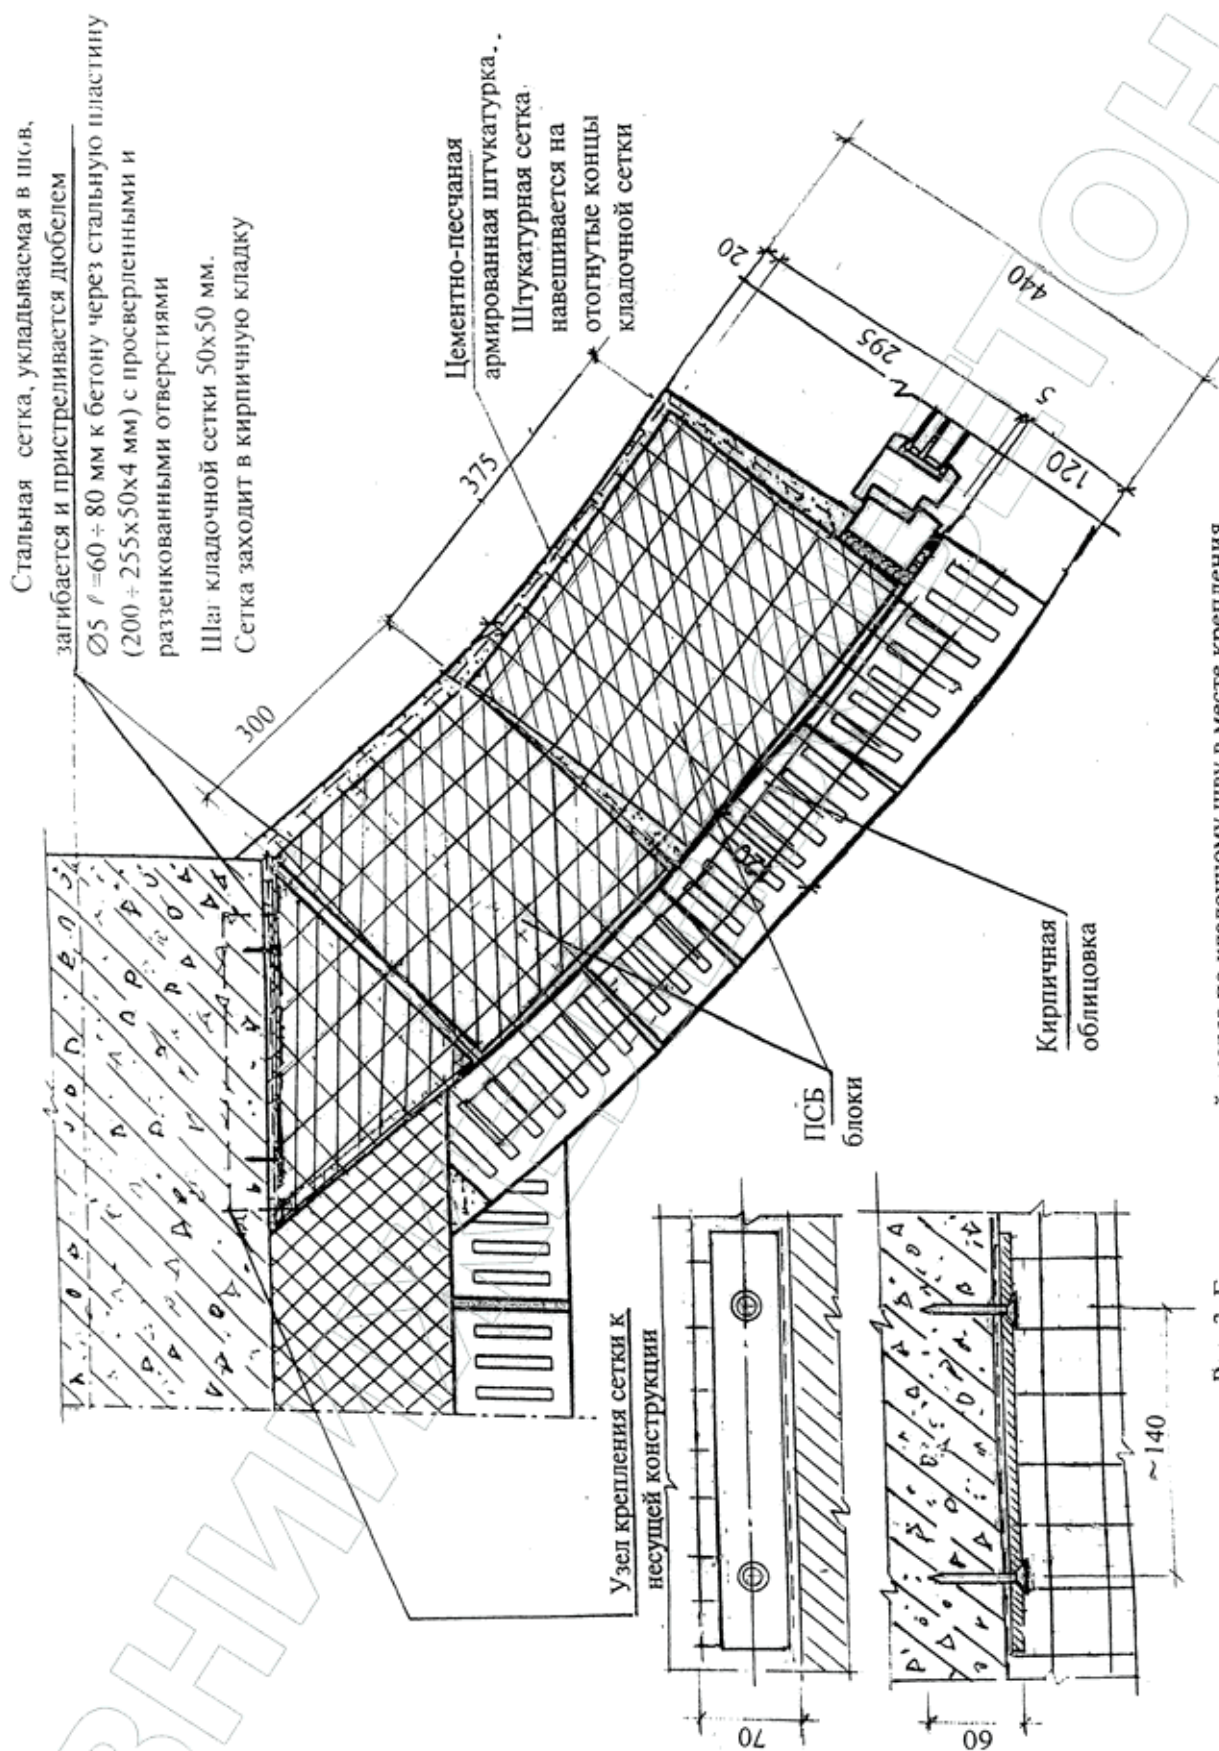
Горизонтальный разрез по кладочному шву в месте крепления кладочных сеток к железобетонной конструкции в эркере
